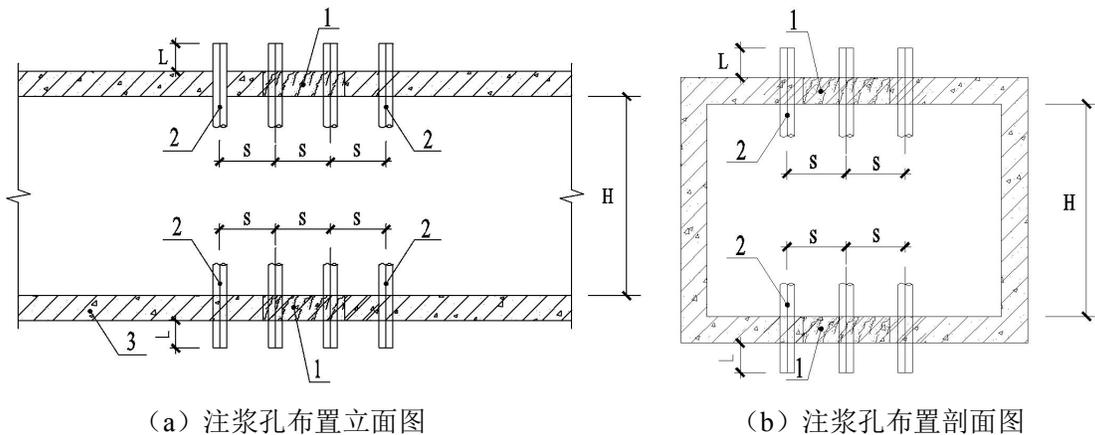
方涵周围土加固的注浆孔布置示意图
